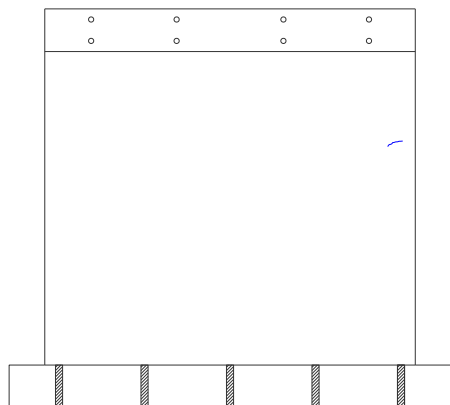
Agrietamiento de muro de albañilería confinada con ladrillos sólido artesanal en la distorsión 1/3000.
